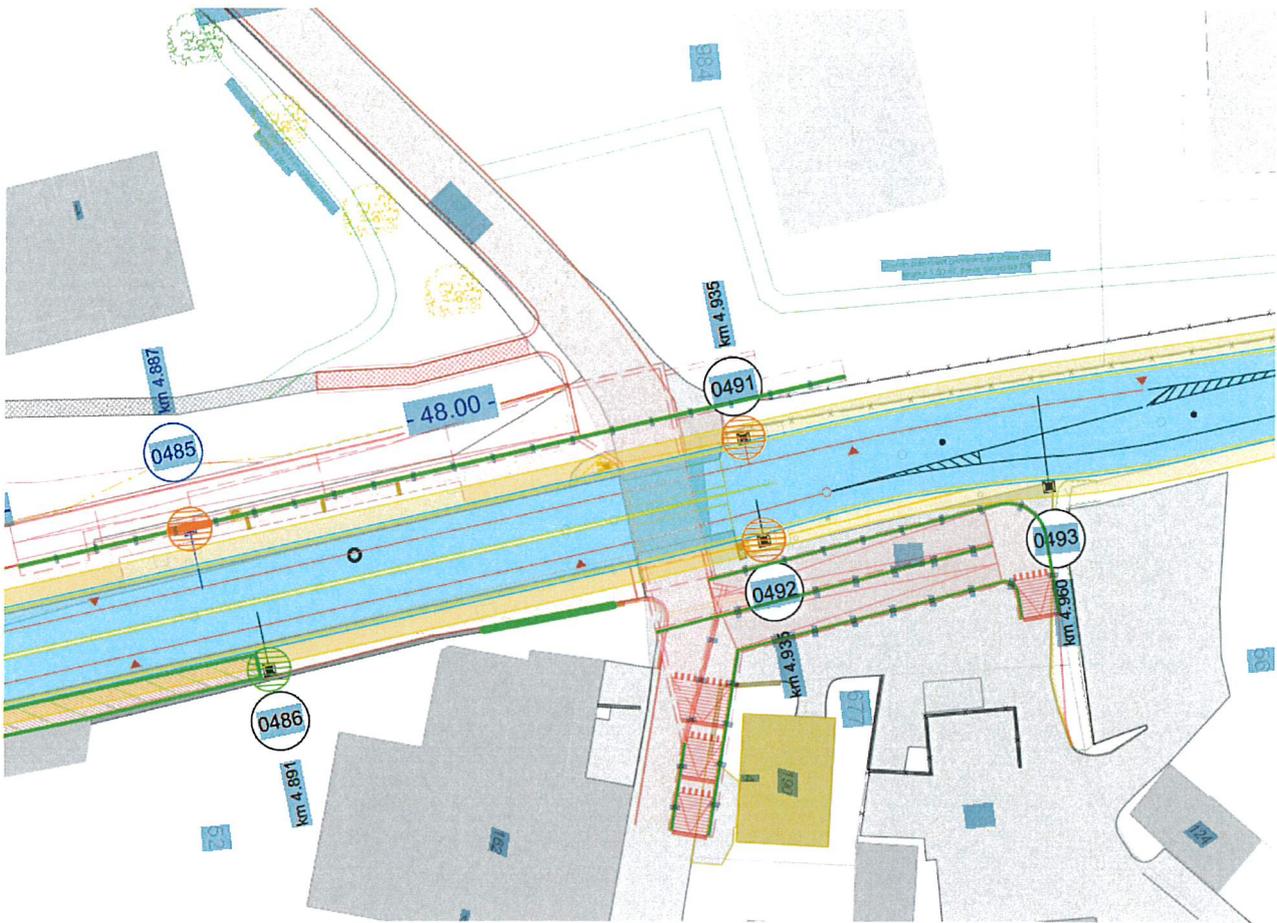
Extrait du plan de situation du projet de passage dénivelé
